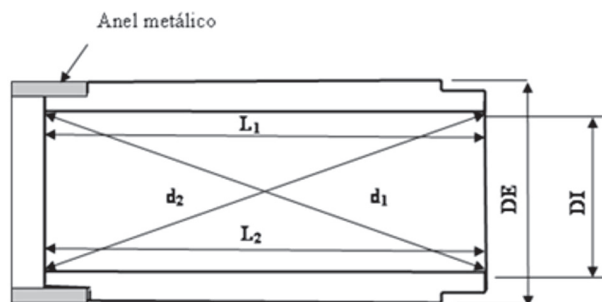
Tubo de concreto para cravação: corte longitudinal - NBR 15319
